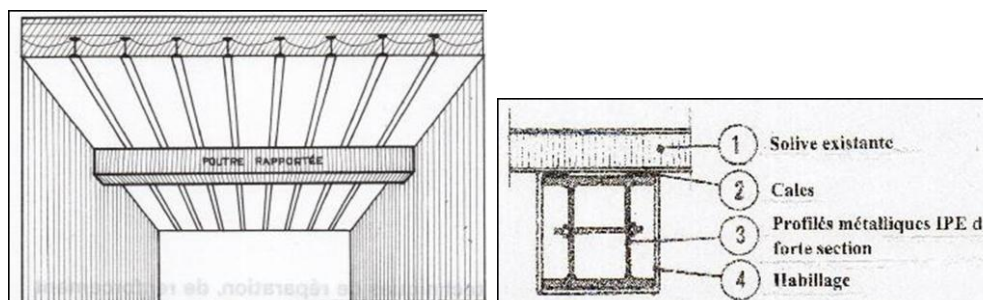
Renforcement d'un plancher métallique par recouplement d'une travure par une poutre métallique
